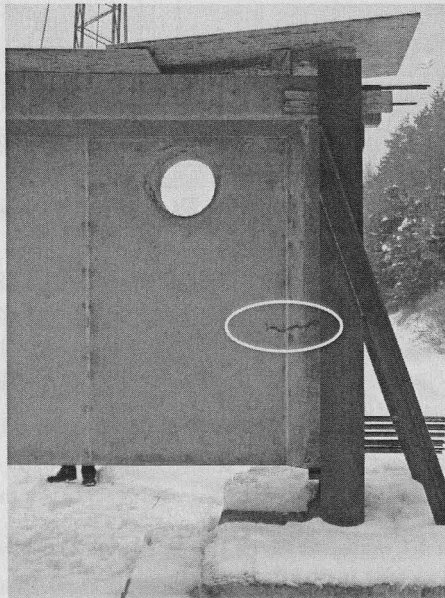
Horizontalriss im Auflagerbereich infolge Spannkraftausbreitung (hier exemplarisch für Balken G09)
